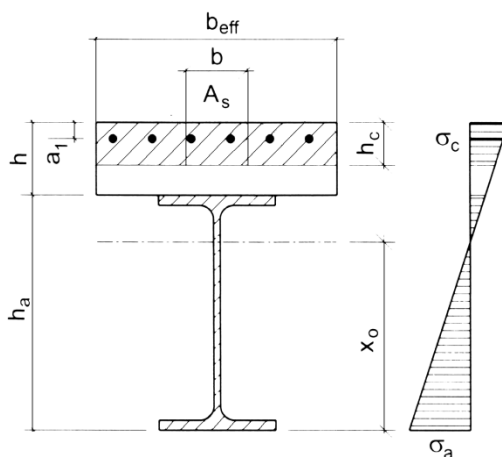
К определению положения нейтральной оси и напряжений в опорном сечении сталежелезобетонной балки
